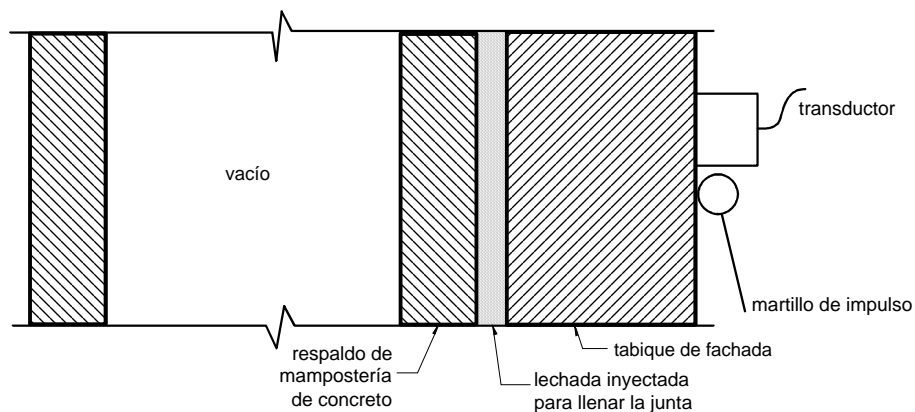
Sección transversal de un muro de mampostería de bloque de concreto estudiado mediante la técnica de medición del eco producido por un impacto. En este ejemplo, las pruebas pretenden determinar si la junta entre el bloque de concreto y la fachada fue efectivamente rellenada durante la inyección de lechada
